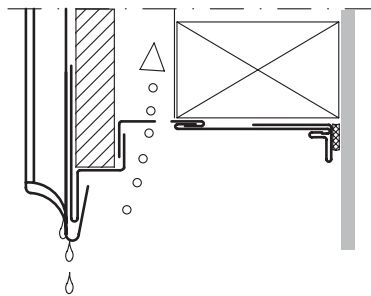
Оконная перемычка с вентилированием и примыканием к оконной раме через дополнительный карман
